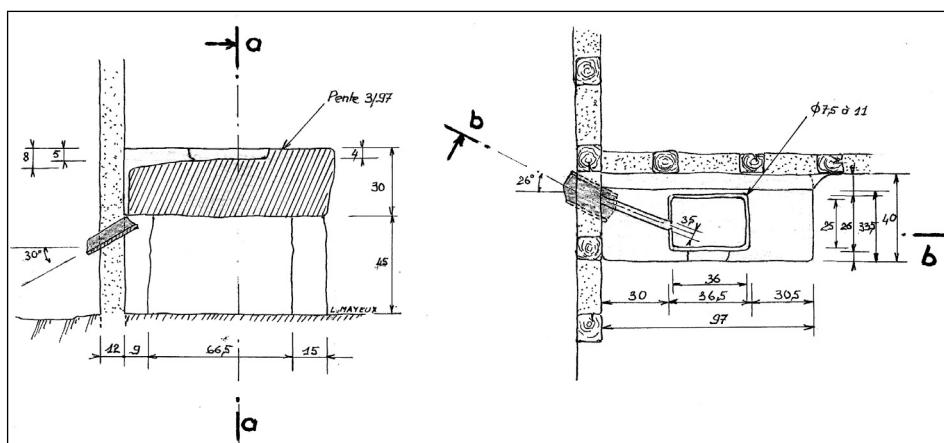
Maison Taffin (croquis de la coupe et plan L. Mayeux).
